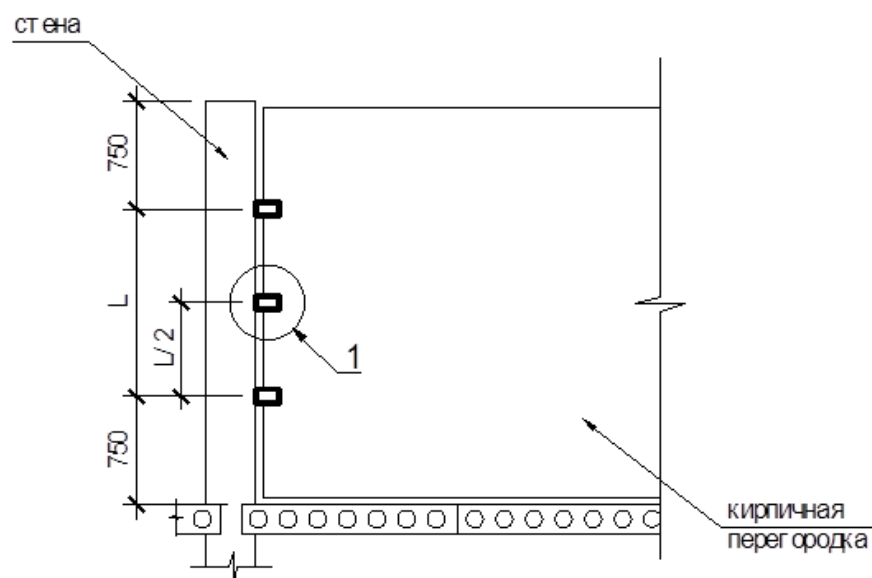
Схема крепления перегородок в местах сопряжения с капитальными стенами закладными деталями.
